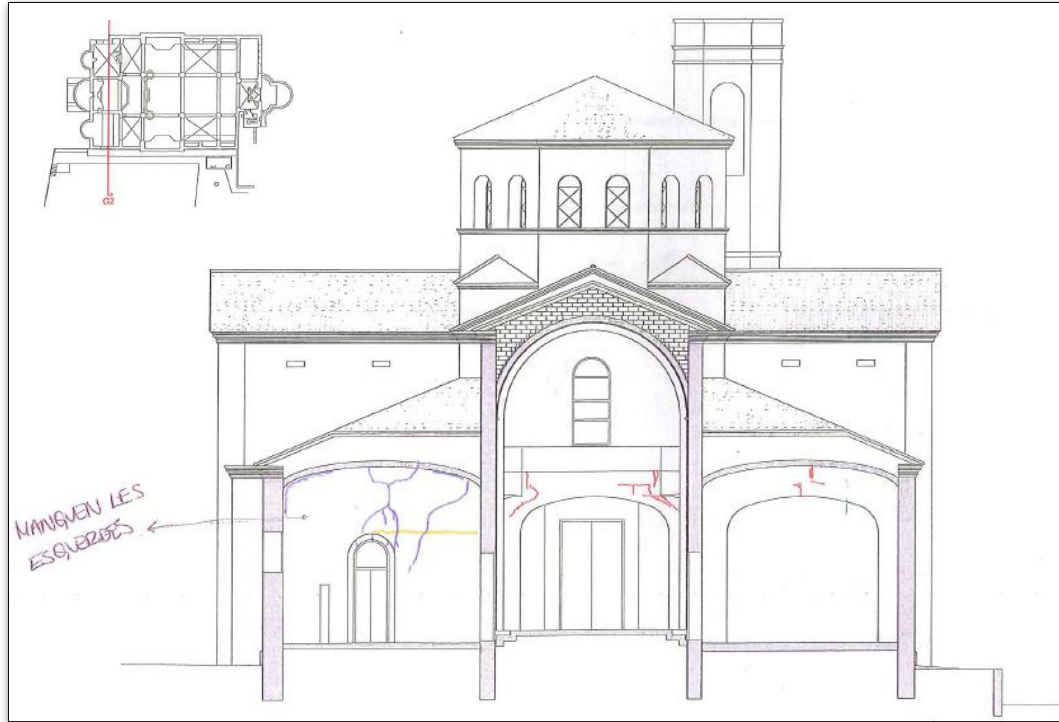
Grietas sección transversal norte 3 (plano PAT. 11)
